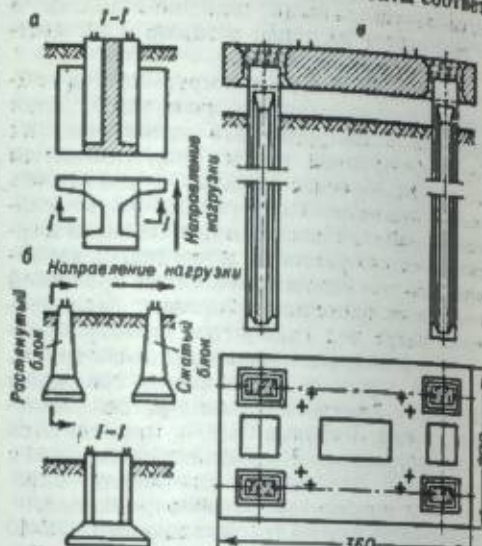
Железобетонные фундаменты металлических опор контактной сети: а — одноблочные, б — раздельные на двух блоках, в — свайные с ростверком.
